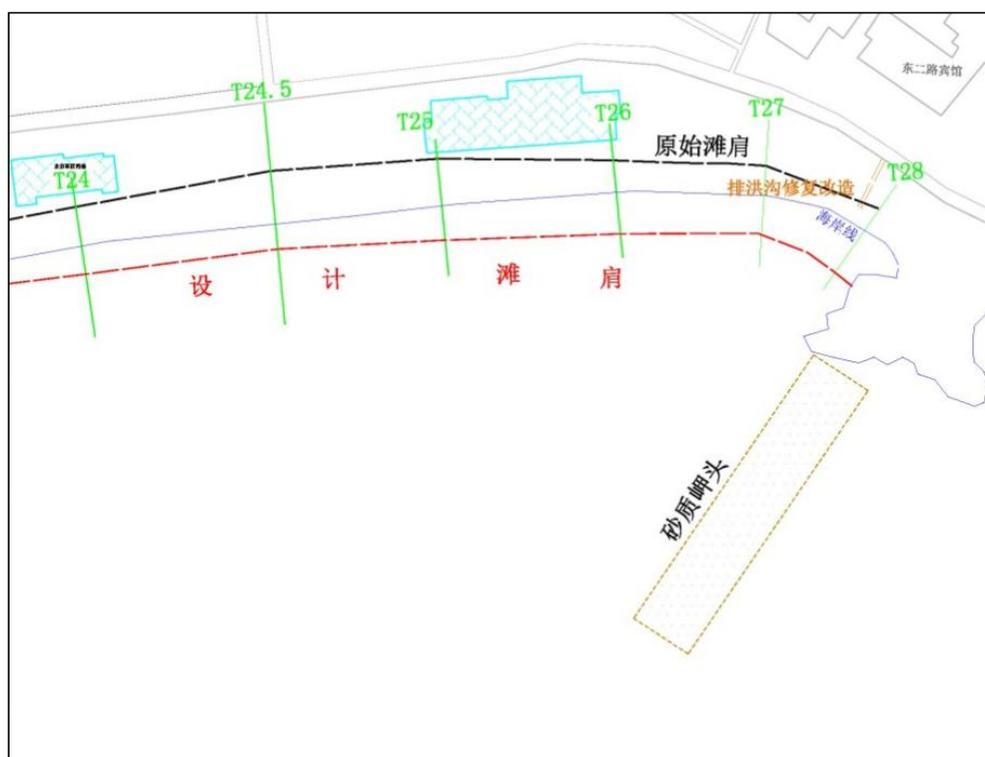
(d) 东二路入海排洪沟及周边岸线整治平面布置图
